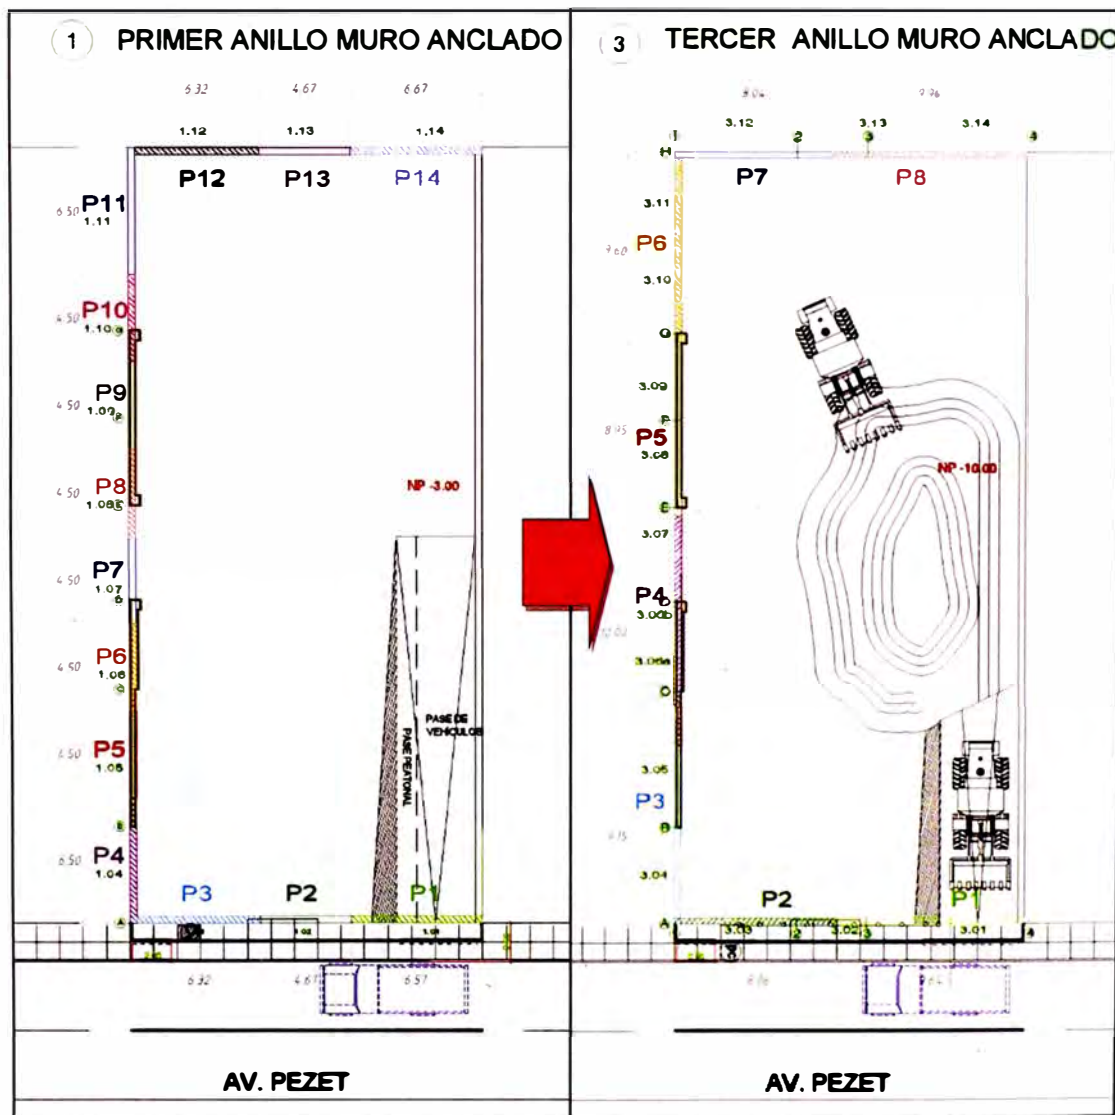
Incremento de paños de vaciado de muro pantalla
